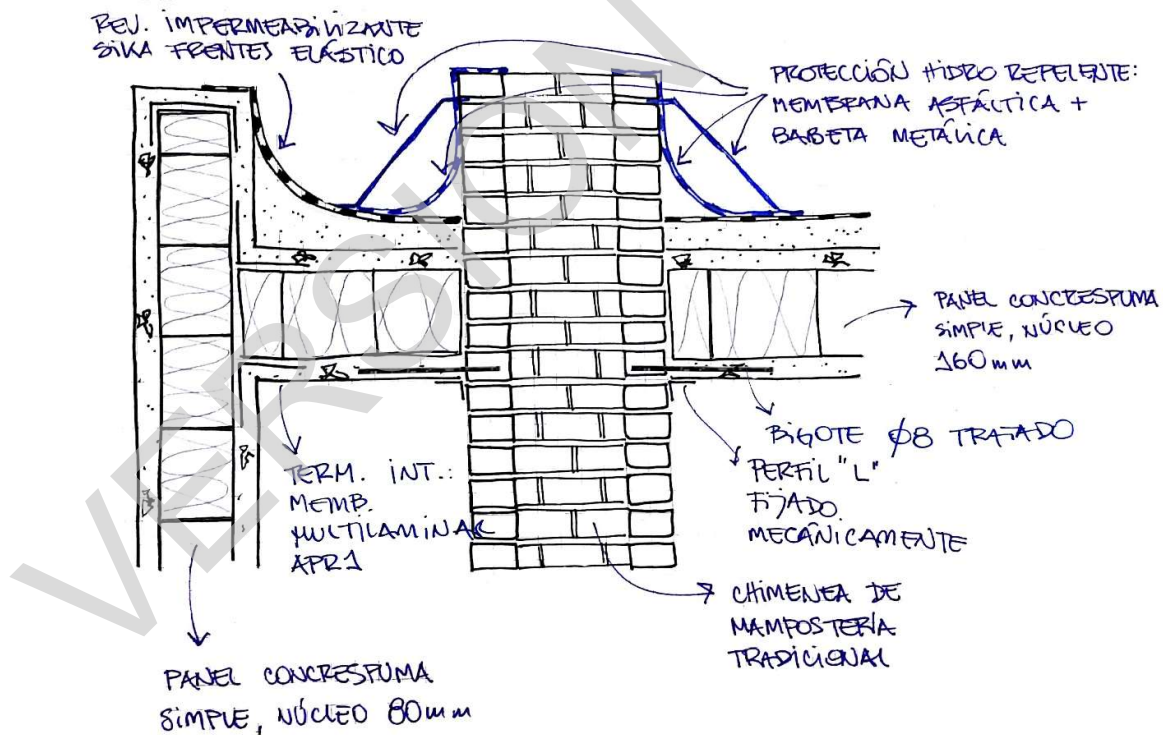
Encuentro de chimenea de mampostería con techo CONCRESPUMA® (croquis ilustrativo)
